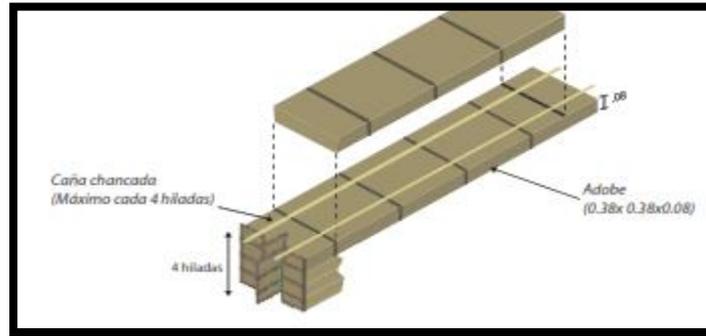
Muro sin refuerzo vertical, adobe de sección cuadrada.
